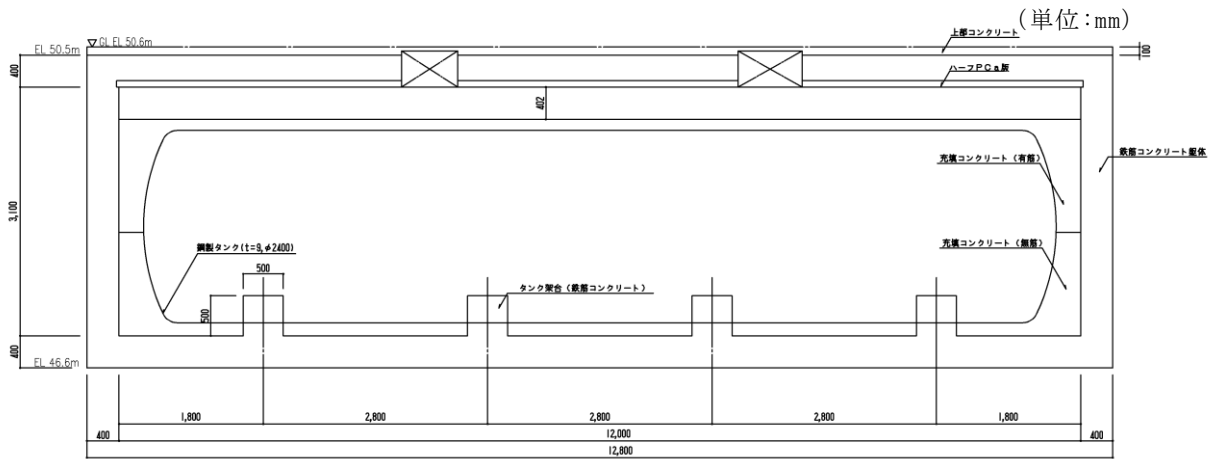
緊急時対策所用燃料地下タンク 断面図 (B-B 断面)
